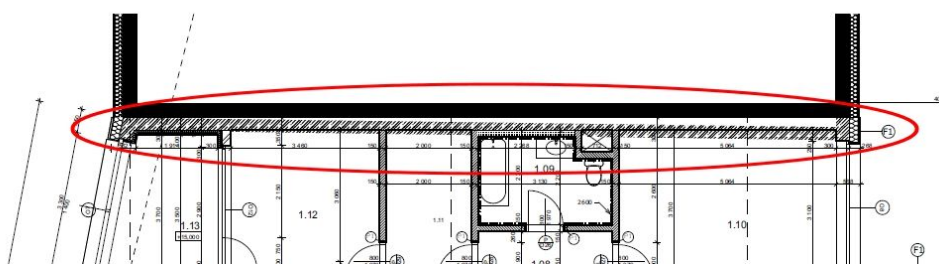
Chybné použití tloušťky čar v půdorysu 1.NP
